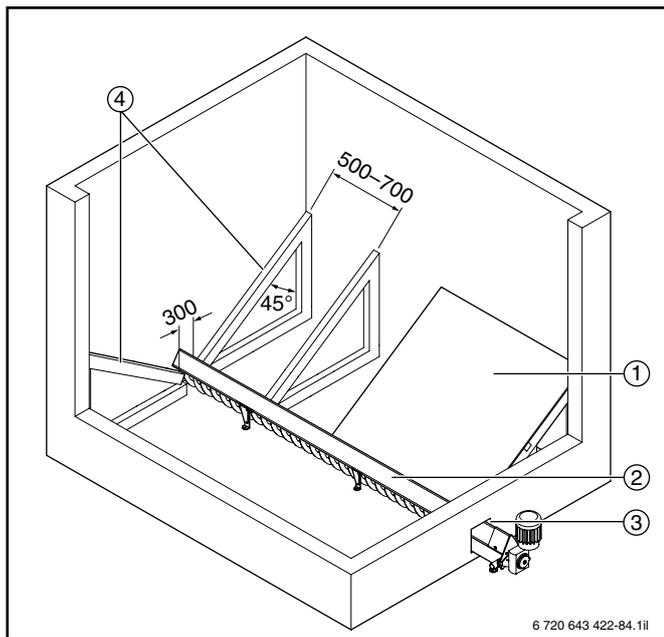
Montaggio del pavimento inclinato (quote in mm)
